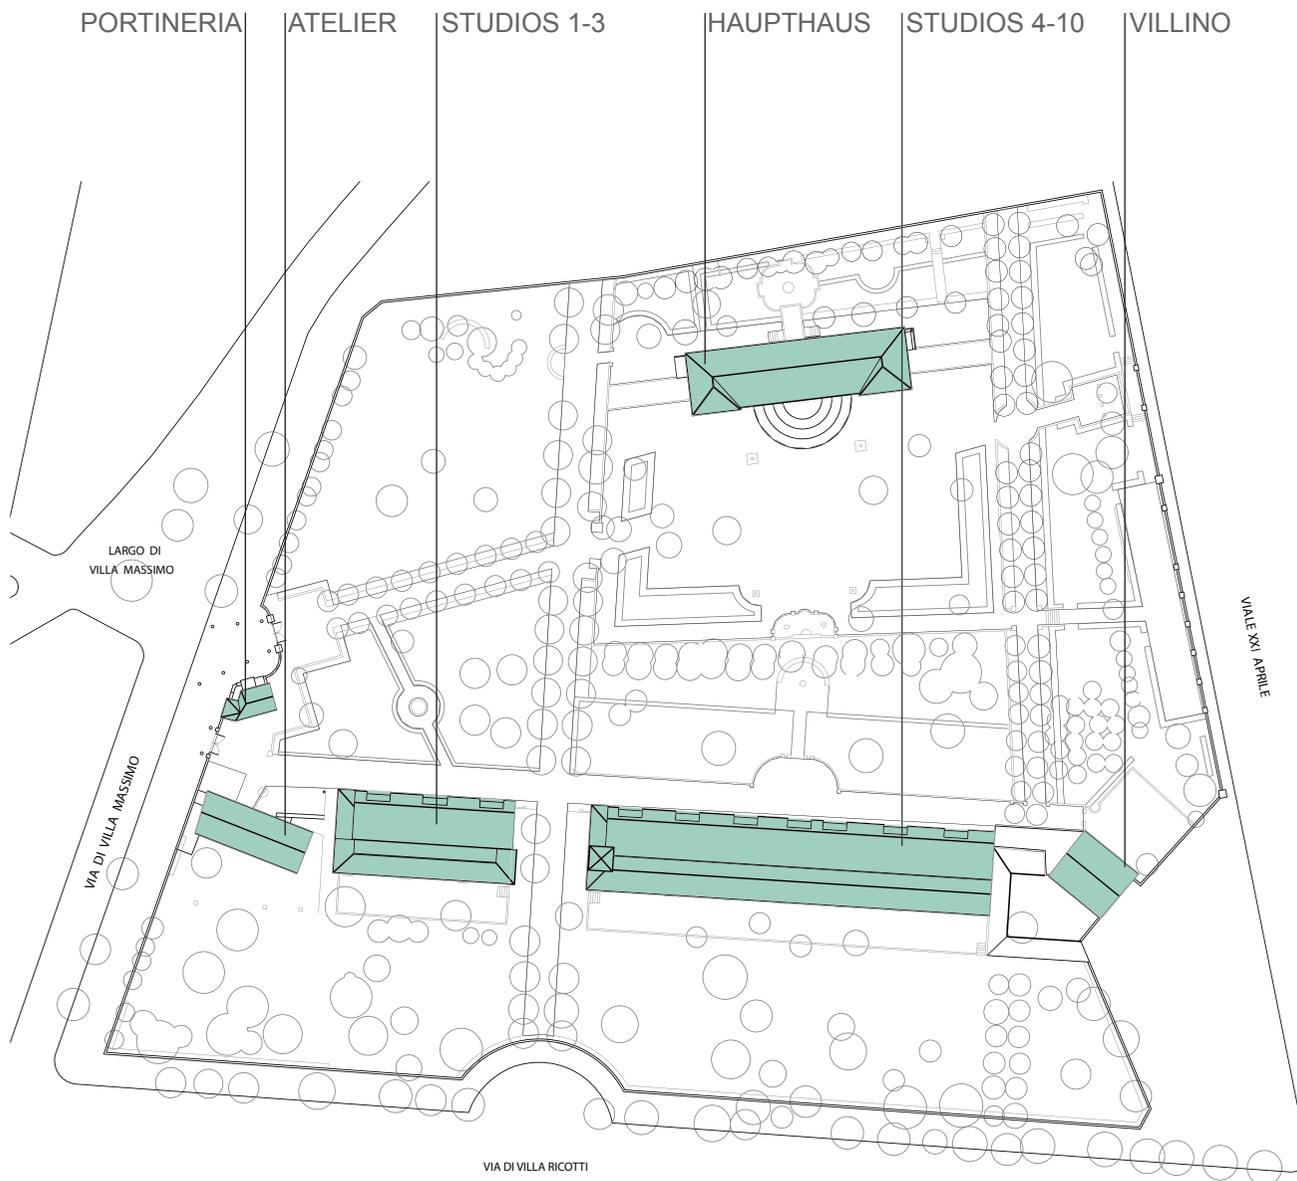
Lageplan Portineria - Atelier - Studios - Villino
